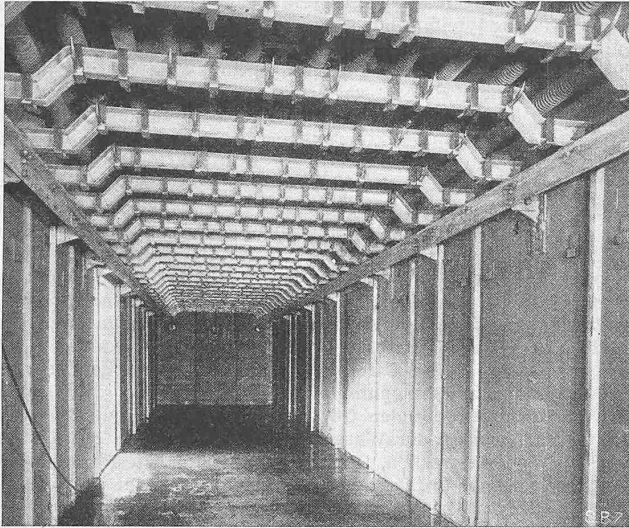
Kühlraum-Innenansicht. Kühlanlage Escher Wyss Maschinenfabriken A. G., Zürich
